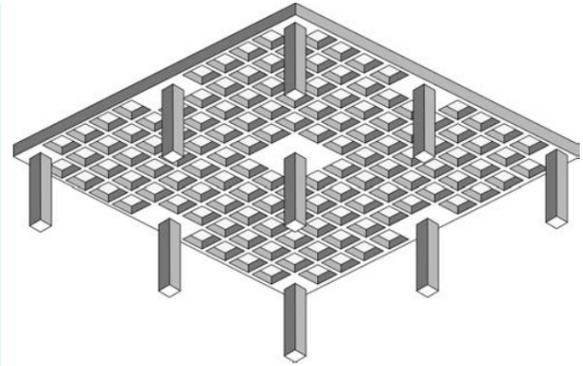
Esquema constructivo para sistema de entrepiso con losa casetonada.
